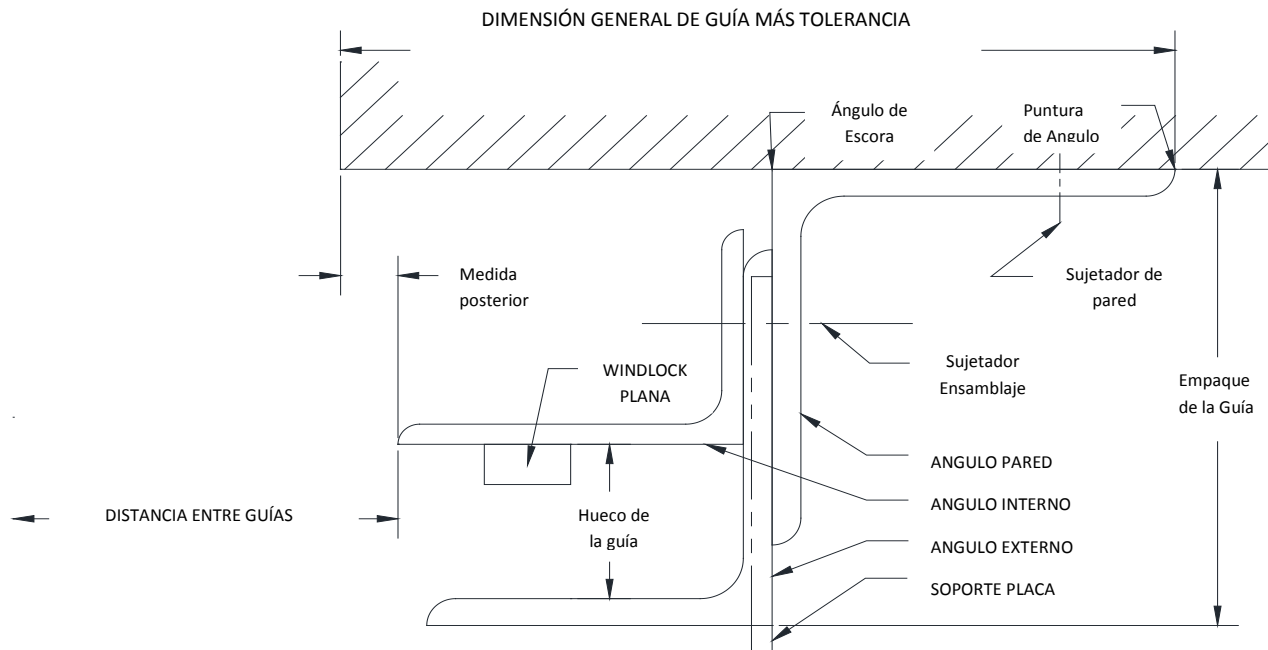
Sobre Muro con Guía “Z” con Windlock Plana
